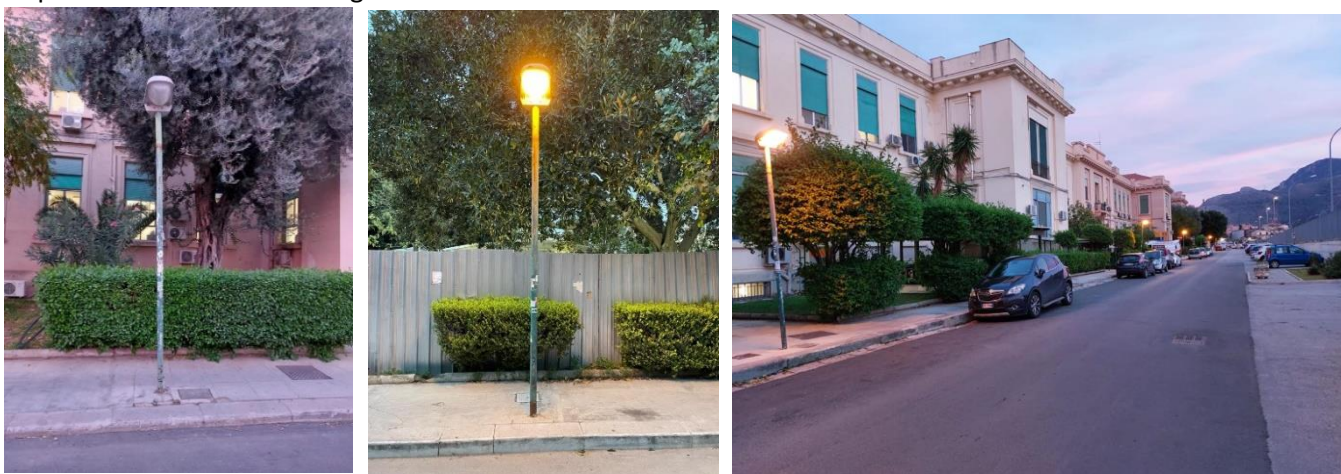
Foto dell'illuminazione esterna dell'ospedale Giaccone di Palermo
